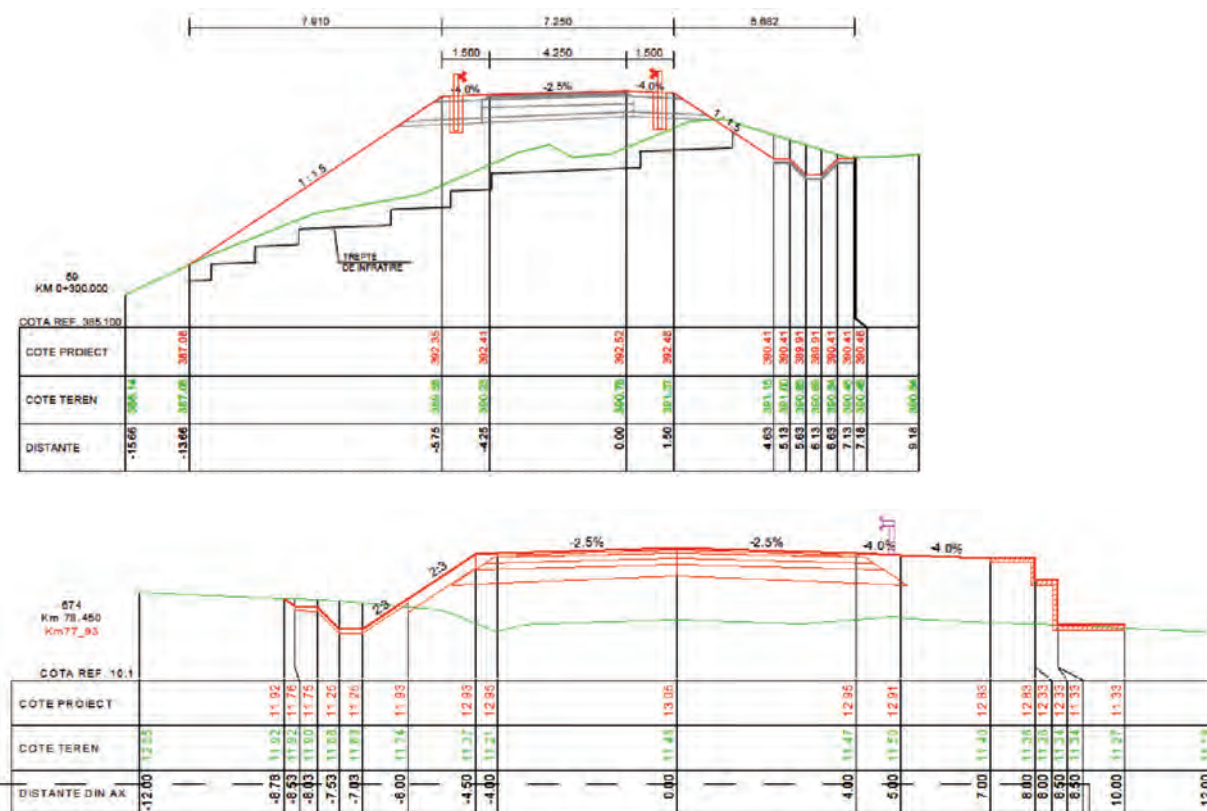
Proiectarea șanțurilor cu Advanced Road Design
